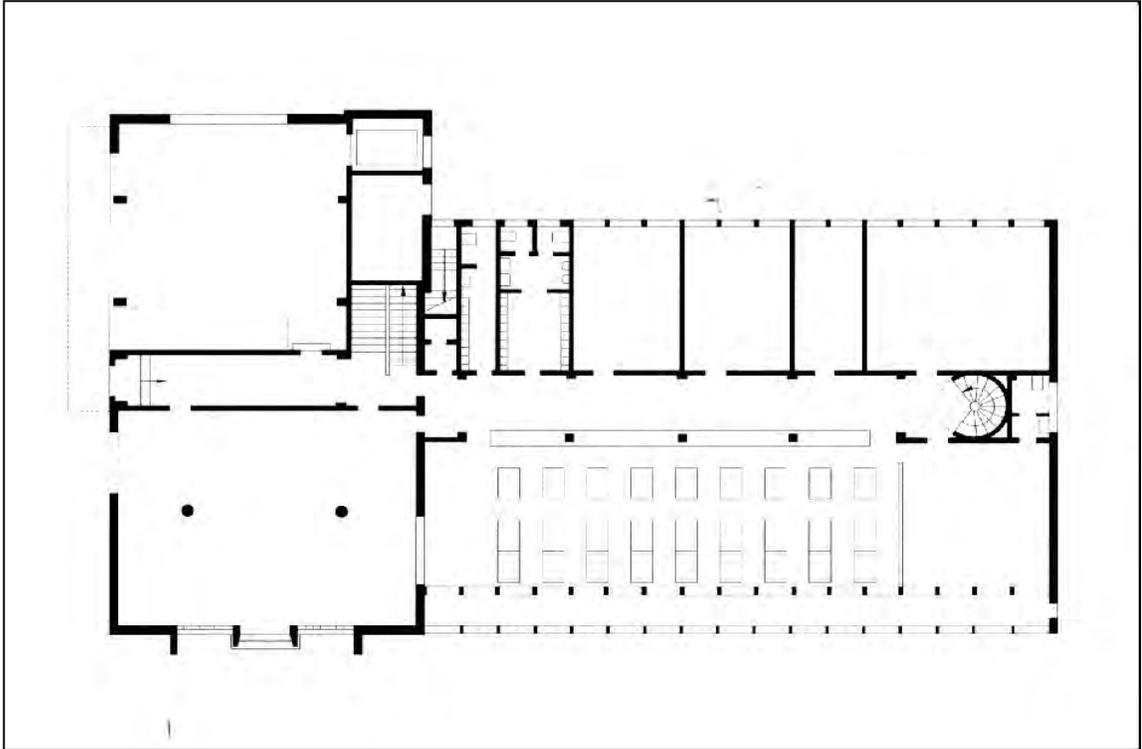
Planta baixa parcial Café Jardim, administração e torre.
